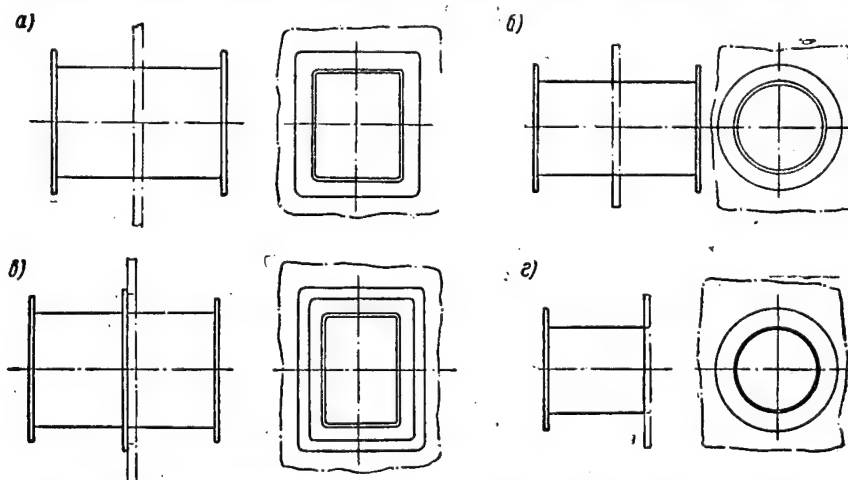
Вентиляционные стаканы: а — прямоугольный; б — круглый; в — со средним фланцем; г — полустакан.
